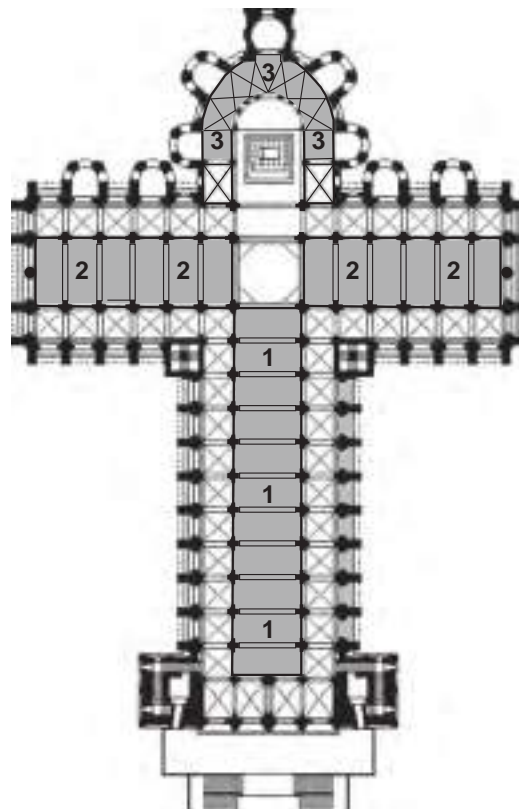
Reconstituição da planta original da *Catedral de Santiago de Compostela*, 1075-1188
